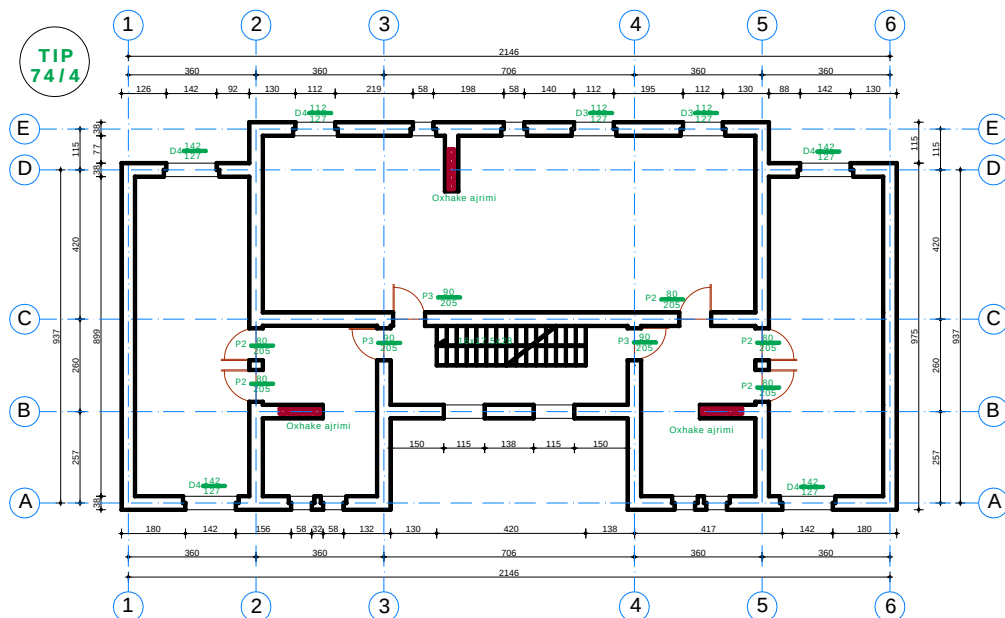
Planimetria e ndërtesës tip 74/4
